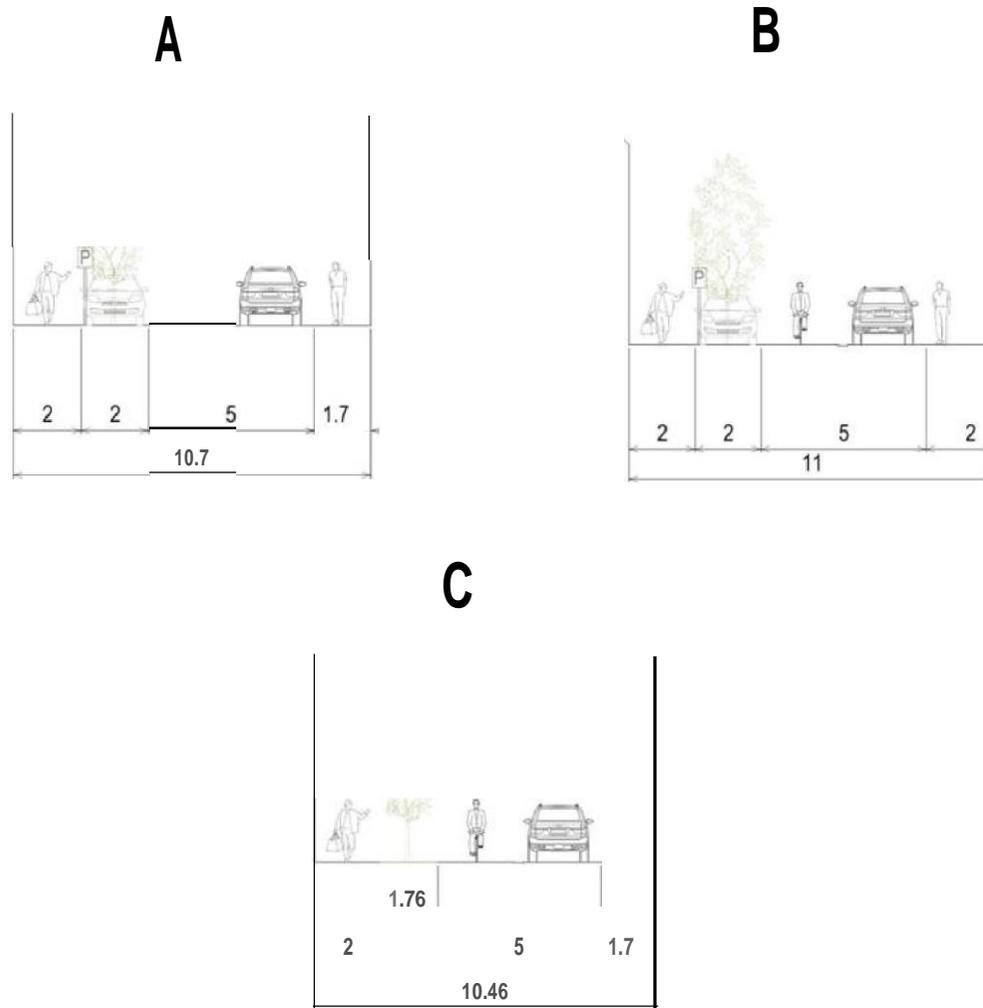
Situation existante de la chaussée de Bruxelles (entre la rue Profonde et la rue I. Meyskens)
